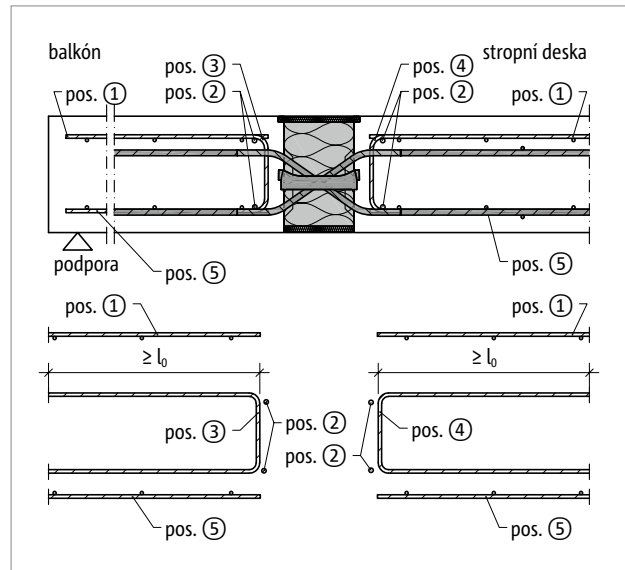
Schöck Isokorb® XT typ QL-V1 až V4: Napojovací stavební výztuž
